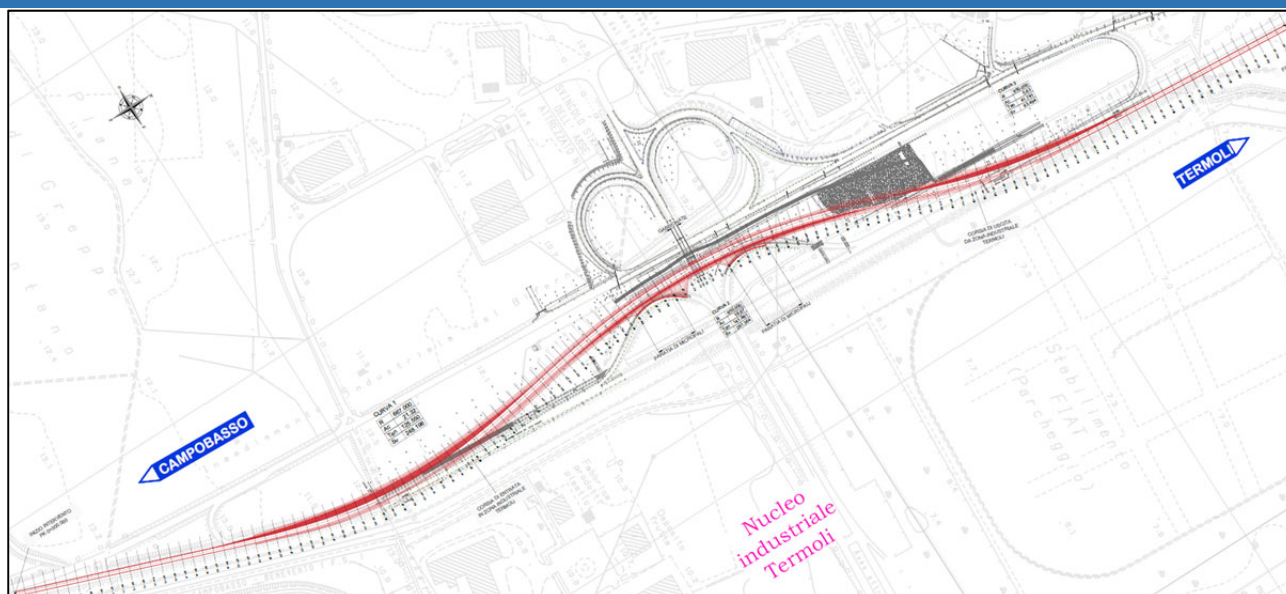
Andamento planimetrico dell'asse stradale
